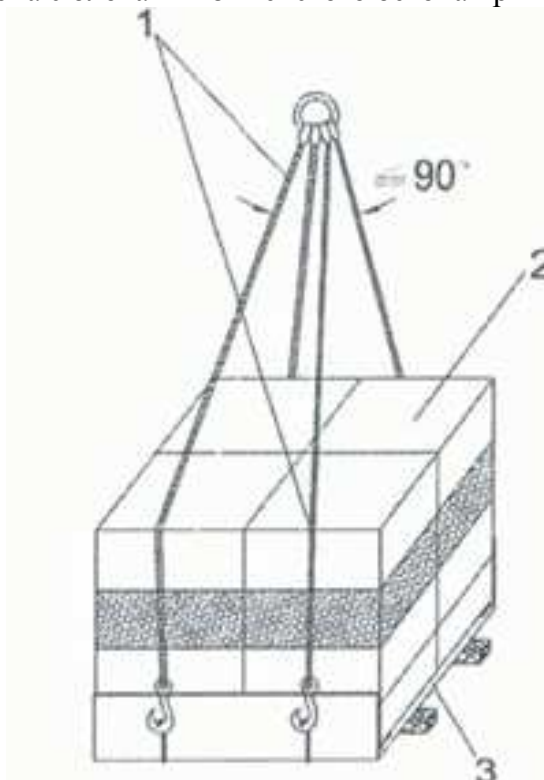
Схема строповки поддона с блоками из ячеистого бетона
